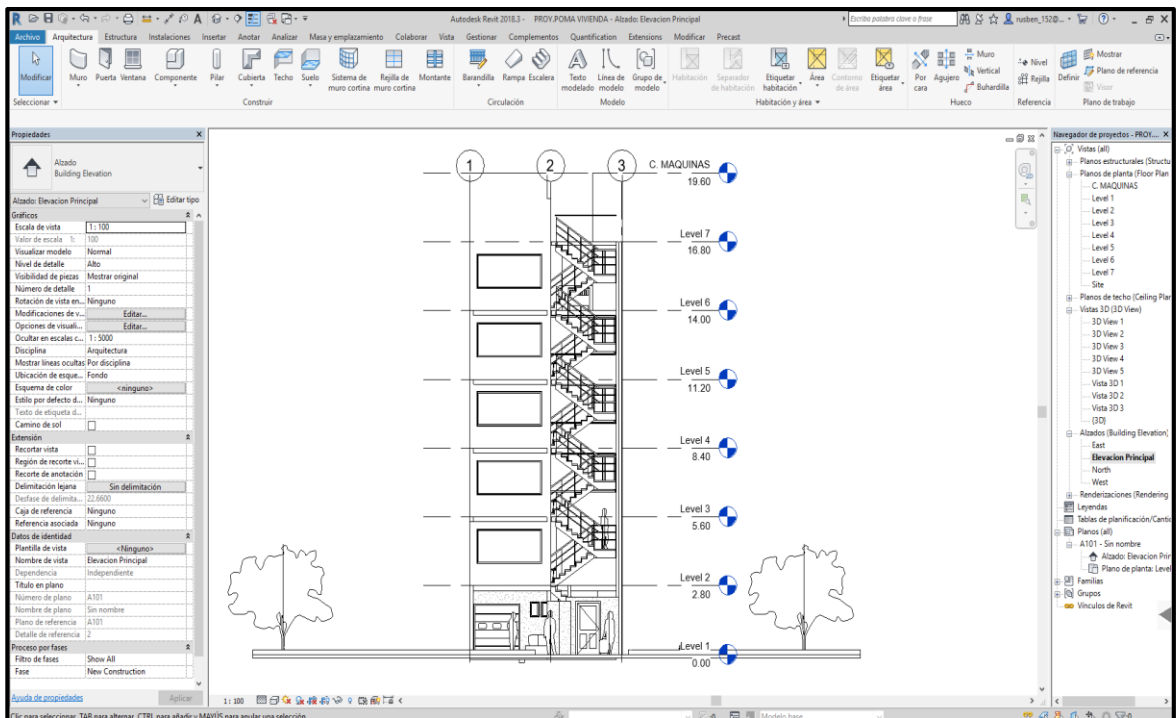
Modelado arquitectónico del edificio Revit - 2018. Vista frontal. Fuente propia
